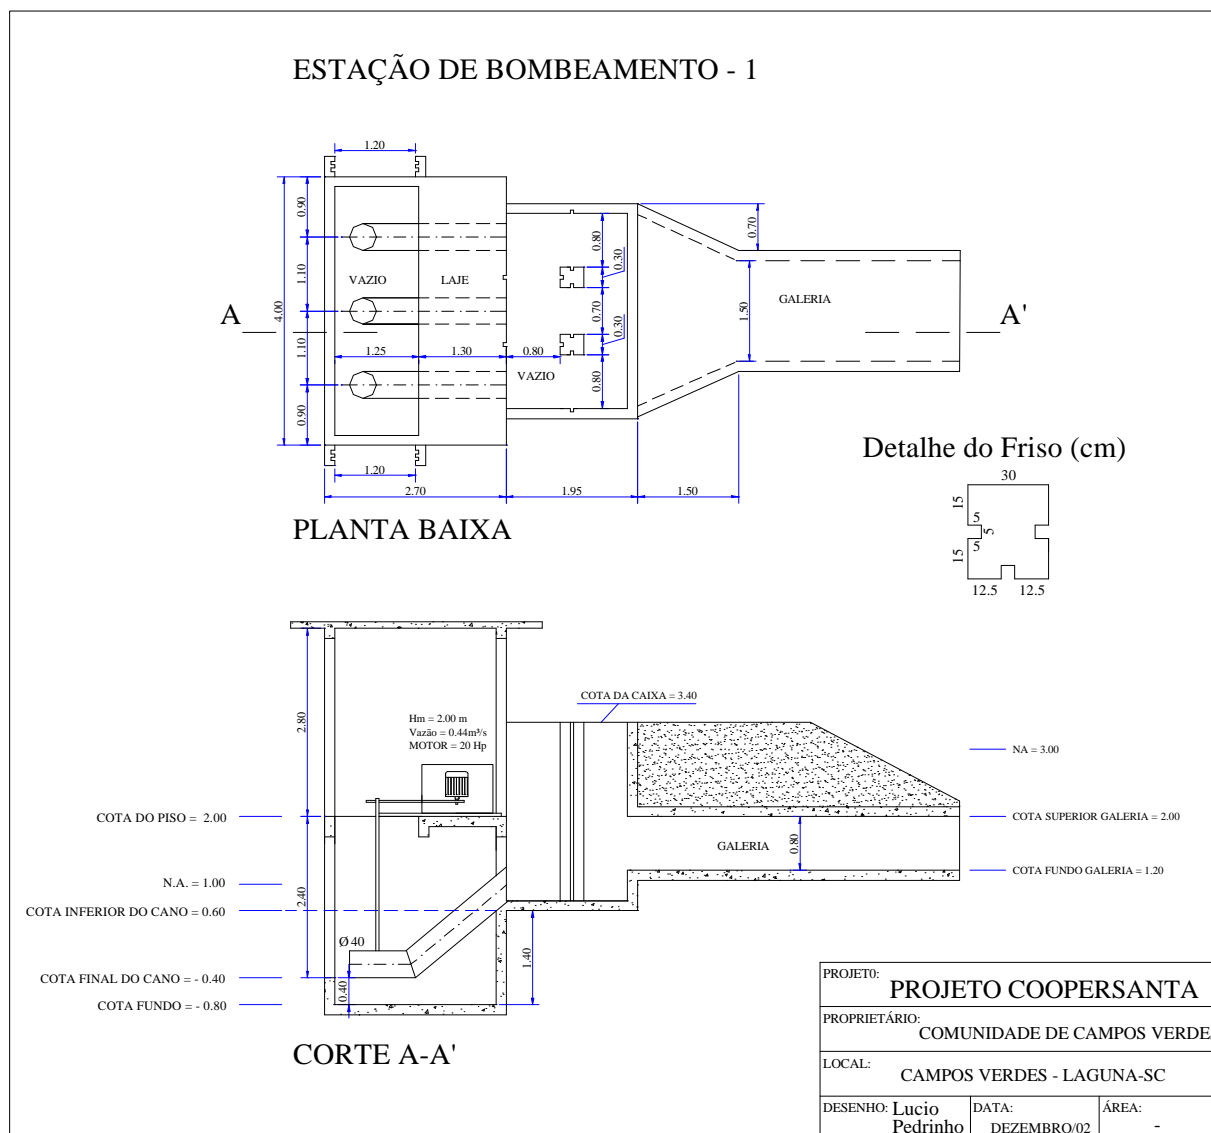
Planta baixa da estação de bombeamento 1 do projeto COOPERSANTA módulo I.
